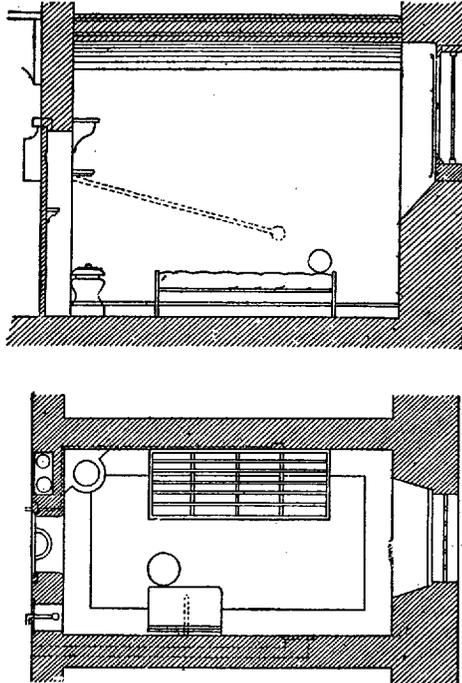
Plan et coupe d'une cellule de la maison d'arrêt de la rue de la Santé, à Paris.
